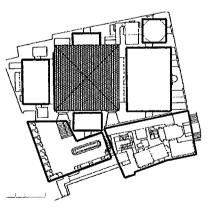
مسقط أفقى مدرسة برسباي [161:200]
